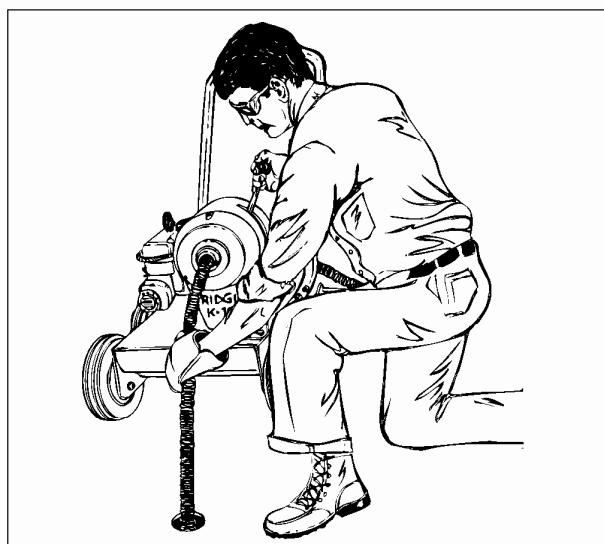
Operação da Máquina para Limpeza de Tubos de Drenagem
